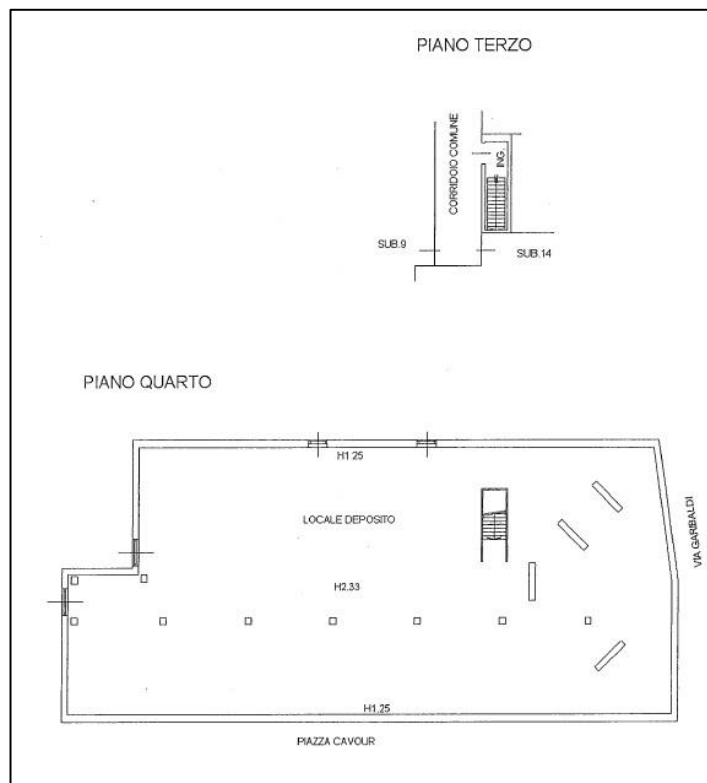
planimetria dell'unità immobiliare ad uso deposito al piano 3°-4°
